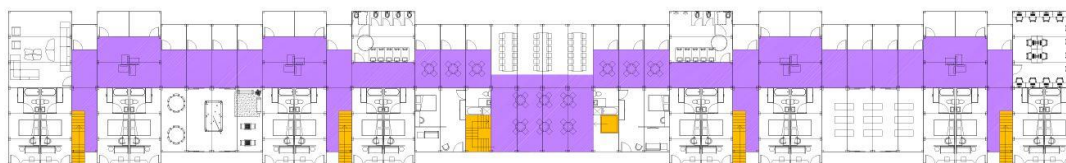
Planta de circulação do primeiro andar; Em amarelo em destaque a circulação vertical e em lilás a circulação horizontal.
